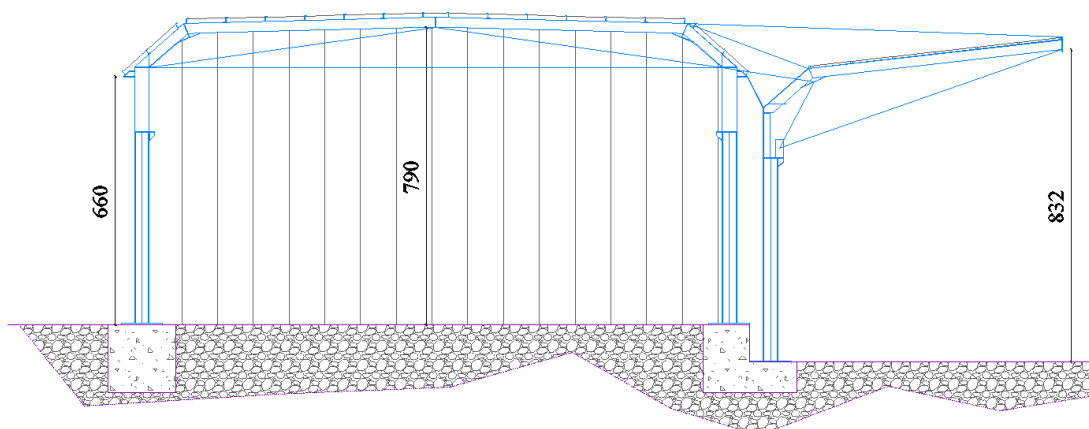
Particolari nuove strutture previste in progetto (PdC - Capannone e tettoia)
